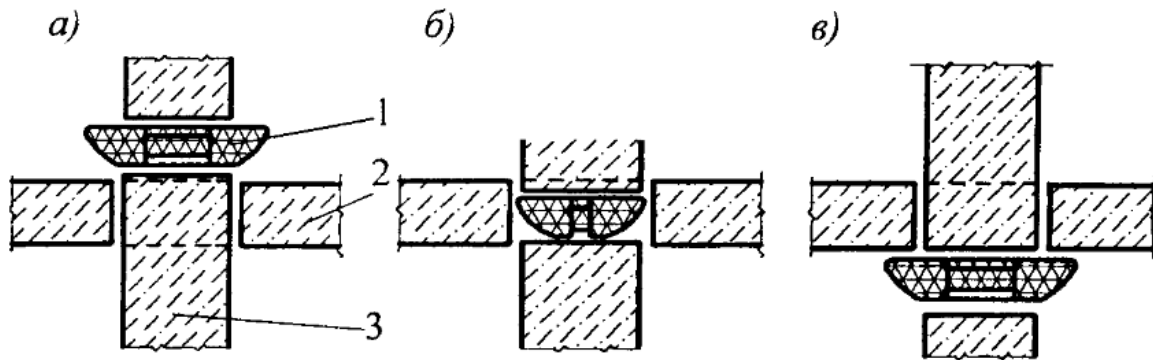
Схема автоматичного закріплення плит перекриття при підйомі:
